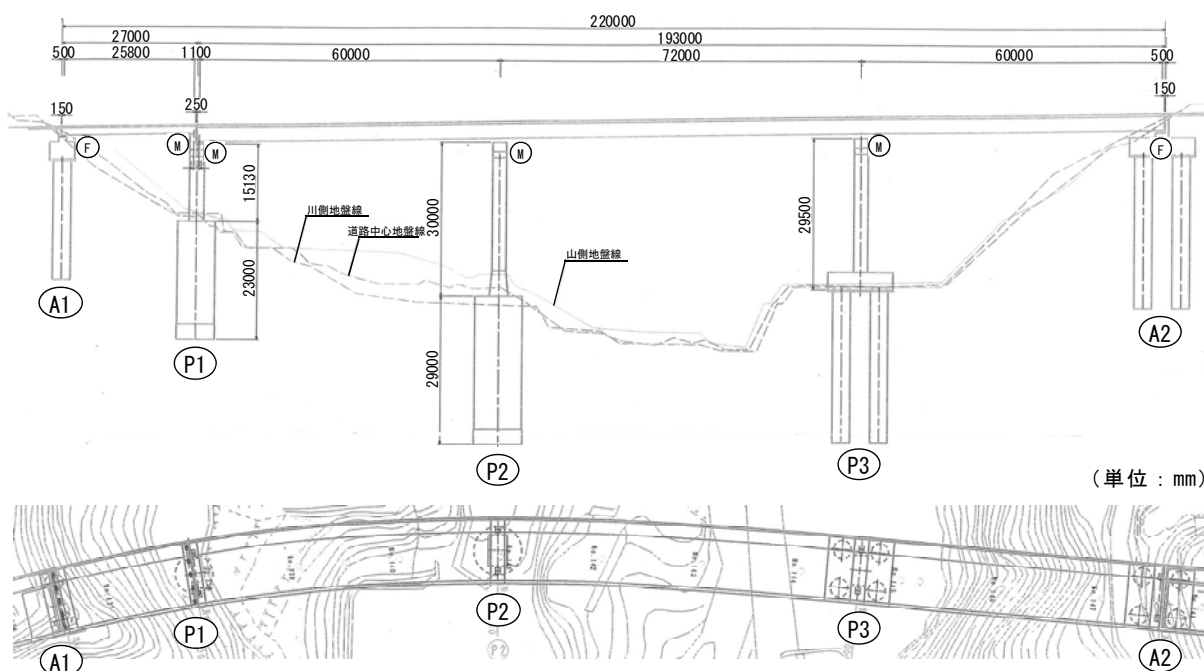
栄大橋(上:側面図, 下:平面図)
